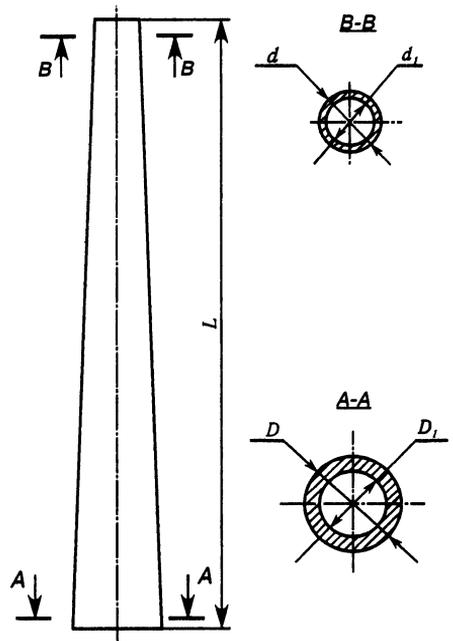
Эскиз центрифугированных железобетонных опор
